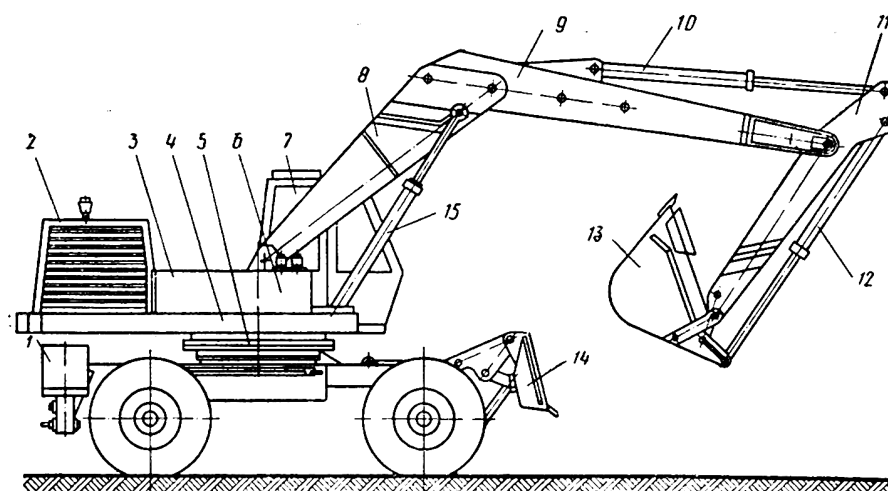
Общий вид экскаватора ЭО-3322:
